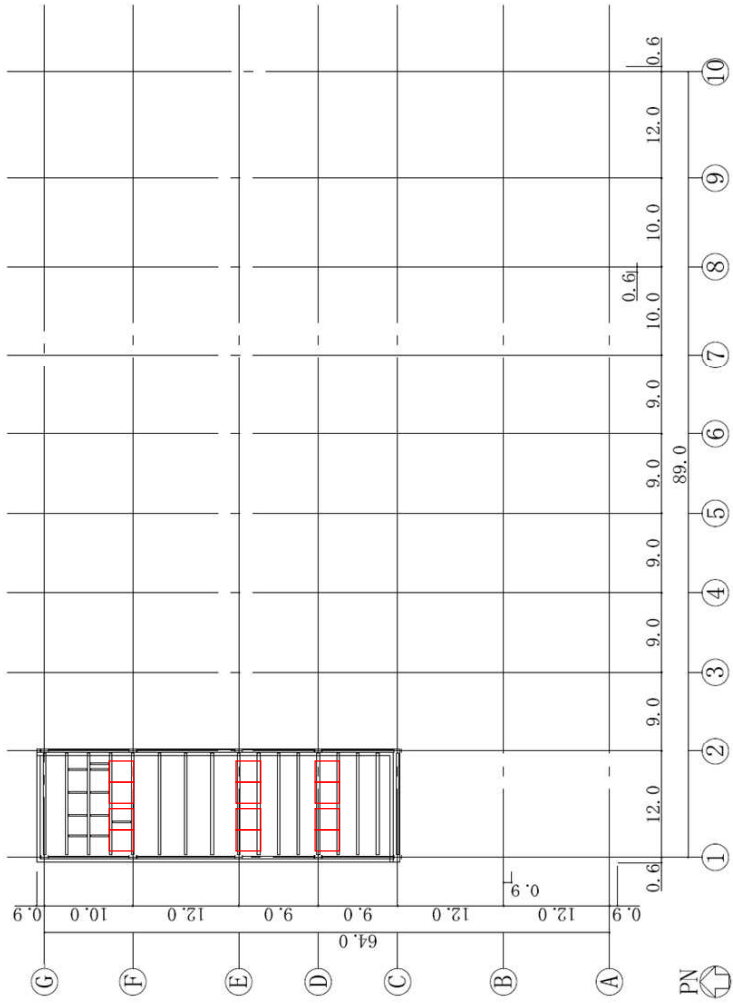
屋上階平面図 (G.L.+10.3) (単位 : m)
